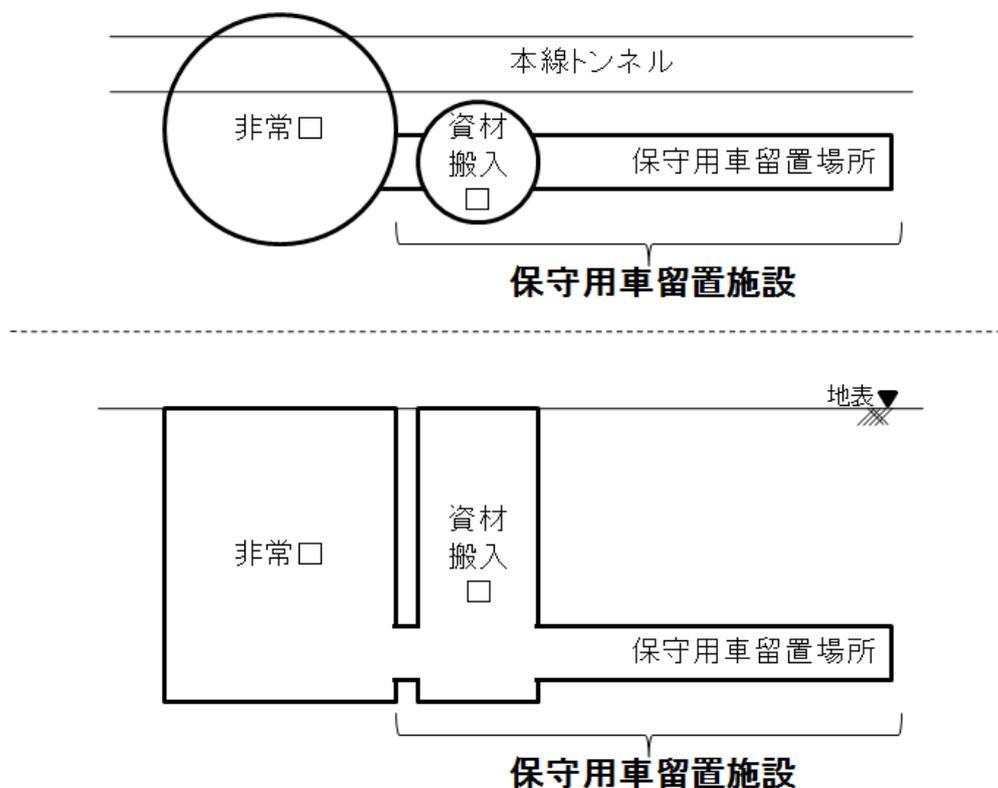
保守用車留置施設の概要（上段が平面図、下段が側面図）
